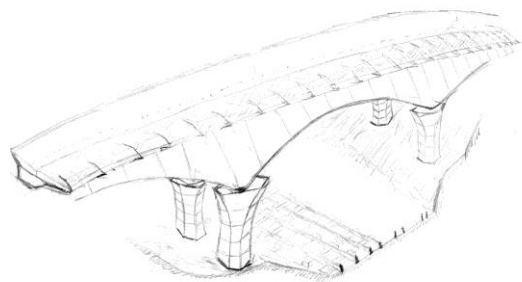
Figura VI: PERSPECTIVA DEL PUENTE VIGA DE HORMIGÓN
